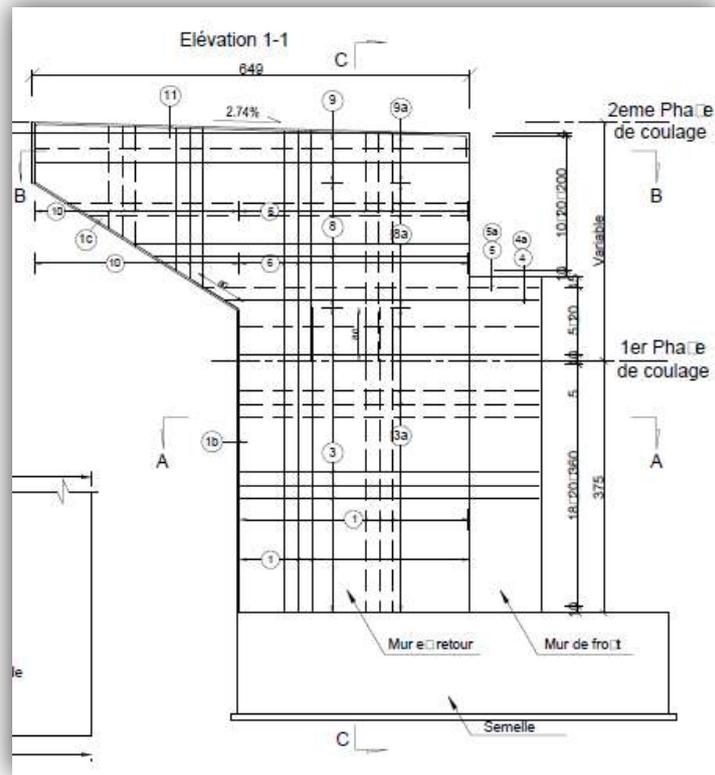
Coupe du mur en retour de la culée C1 [3]
